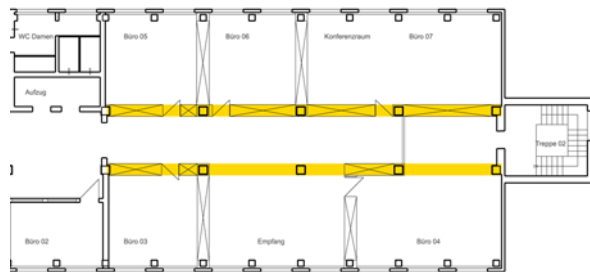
Ausschnitt - Grundriss 2.0G
